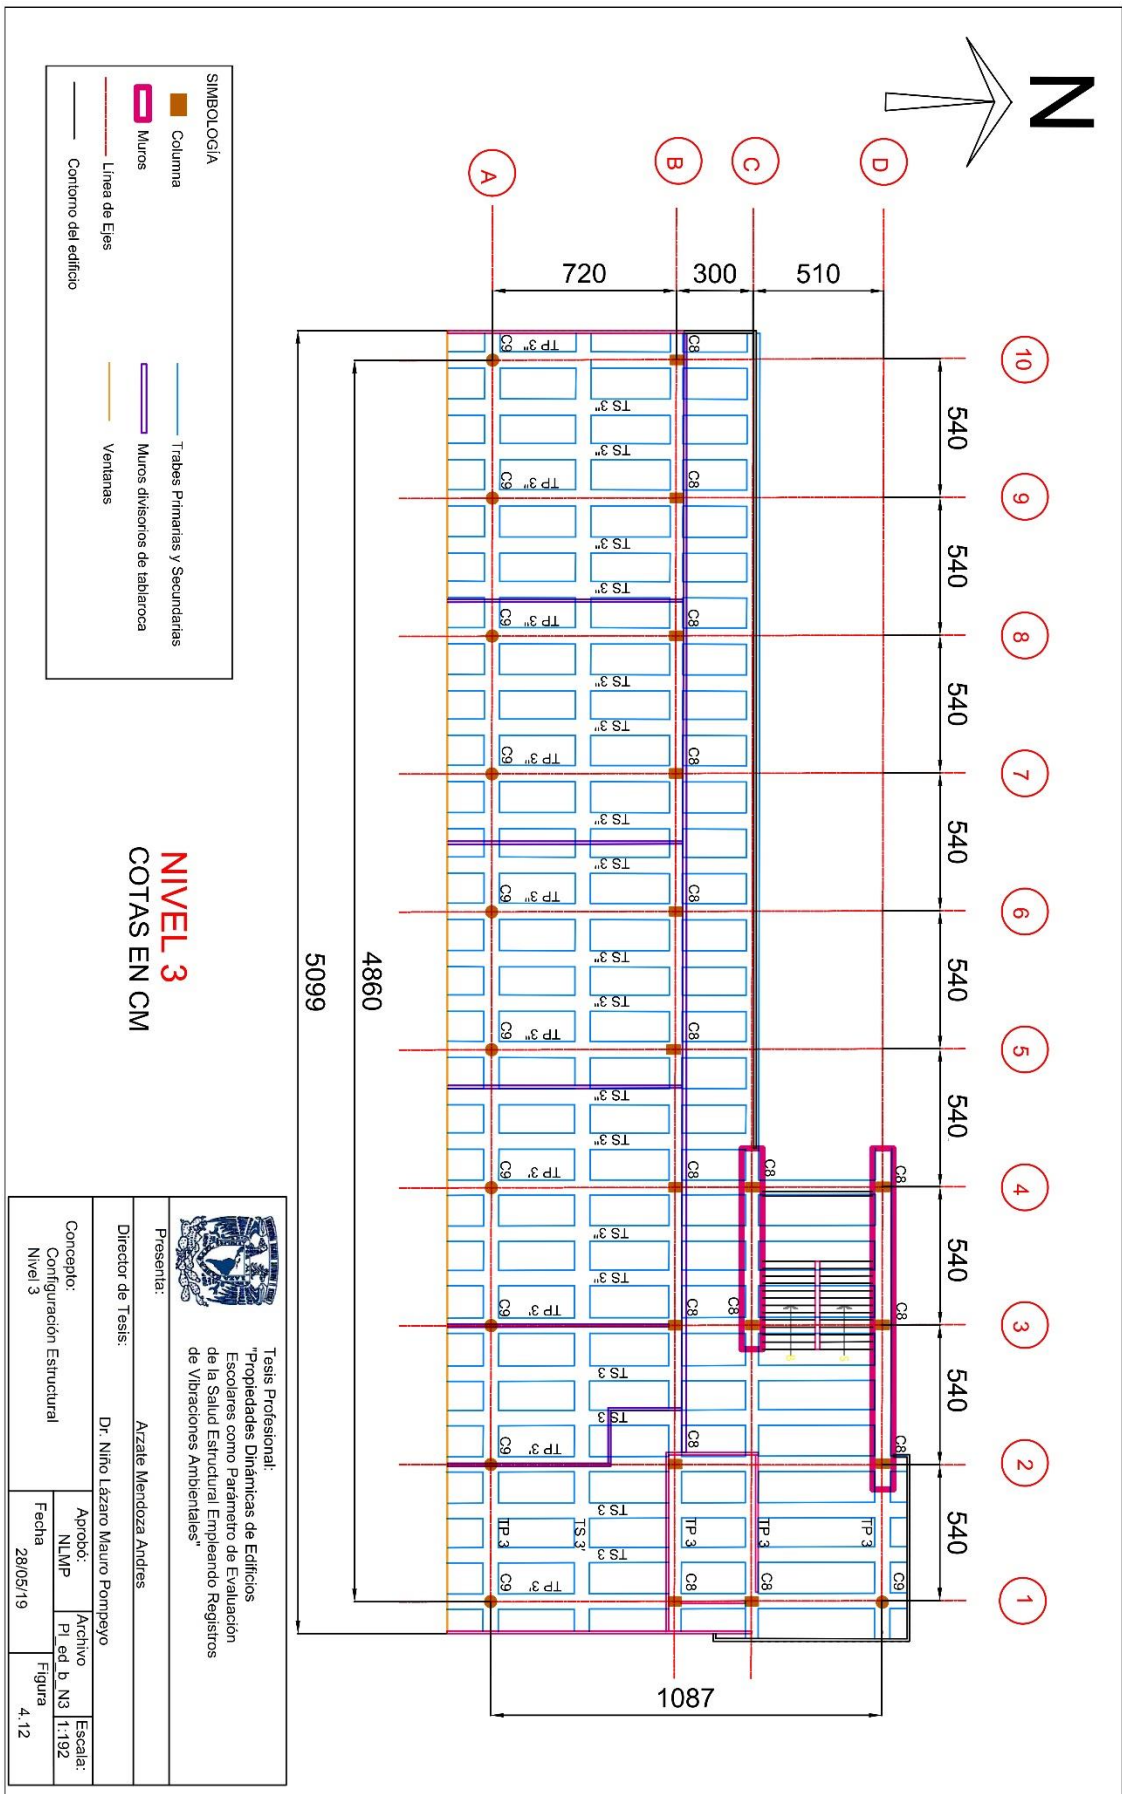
Planta estructural nivel 3 edificio B FI, UNAM
